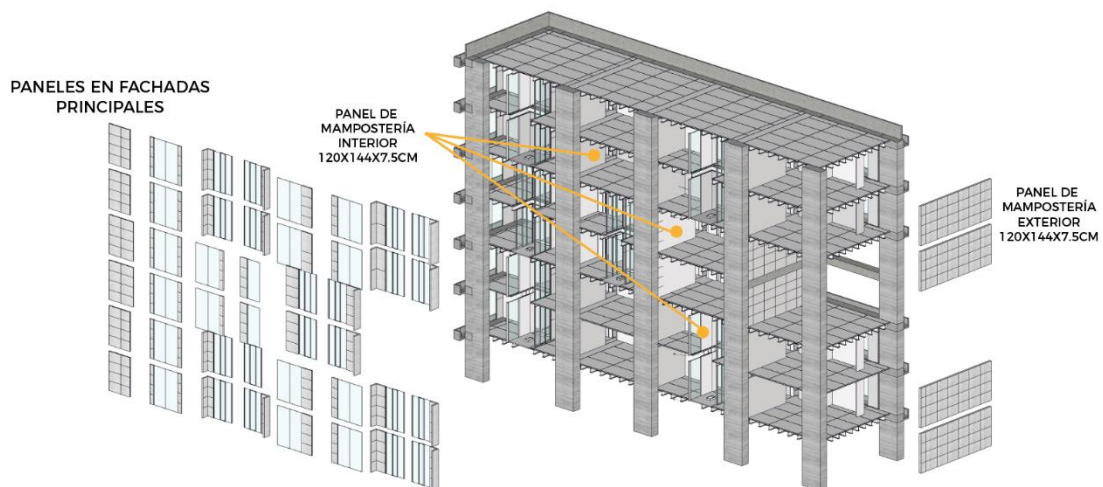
Sistema Prefabricado de Paneles para Mampostería
